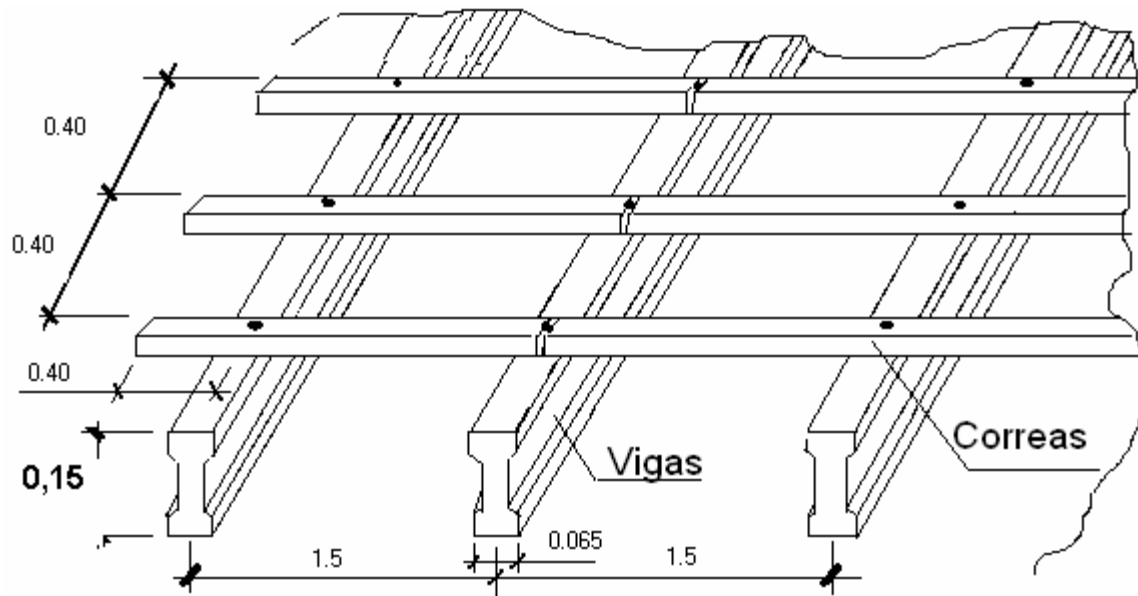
Tecnología SIPRET. Distribución de Vigas y Correas. (Dimensiones en metros)
